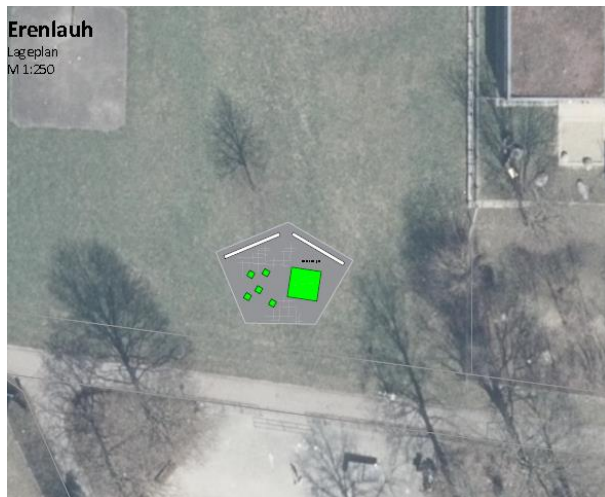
Lageplan Unterstand Jugend, Quelle: Stadt Ulm
